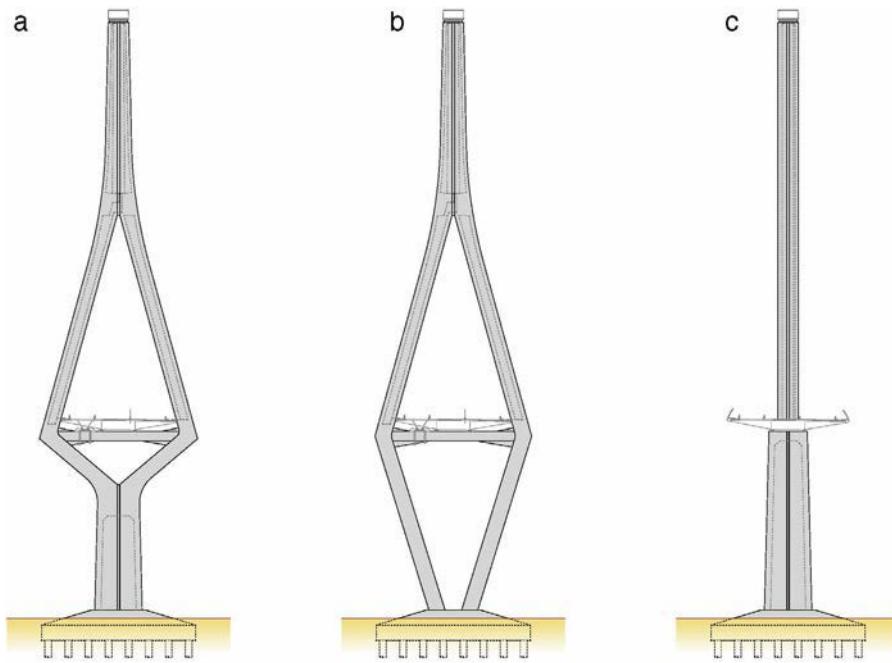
Distintas configuraciones de las torres de atirantamiento.
